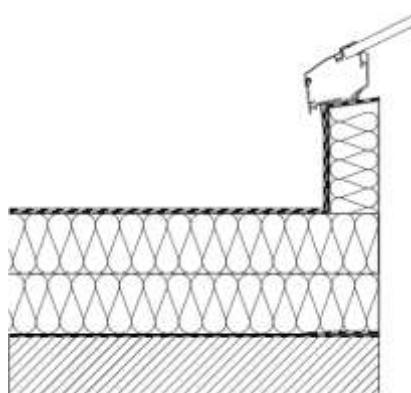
4: Beispiel für ein Lichtband in einem wärmegedämmten, nicht belüfteten Dach mit Abdichtung auf Beton
